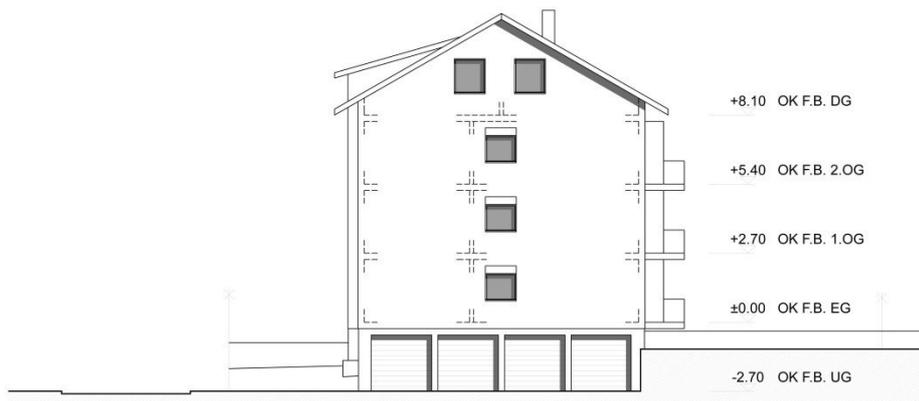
Fallbeispiel, Plan Nordost-Fassade
